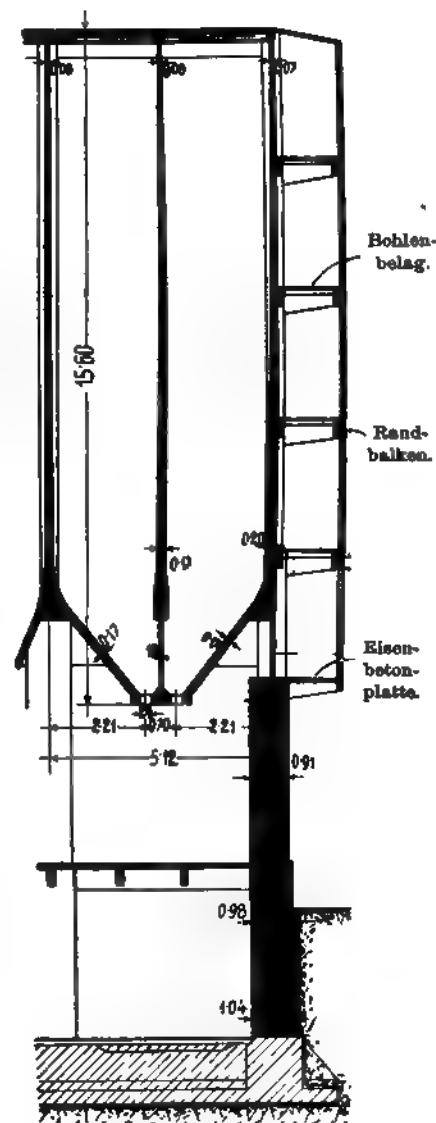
Ausgekrante Laufbrücken an einem Silogebäude.
